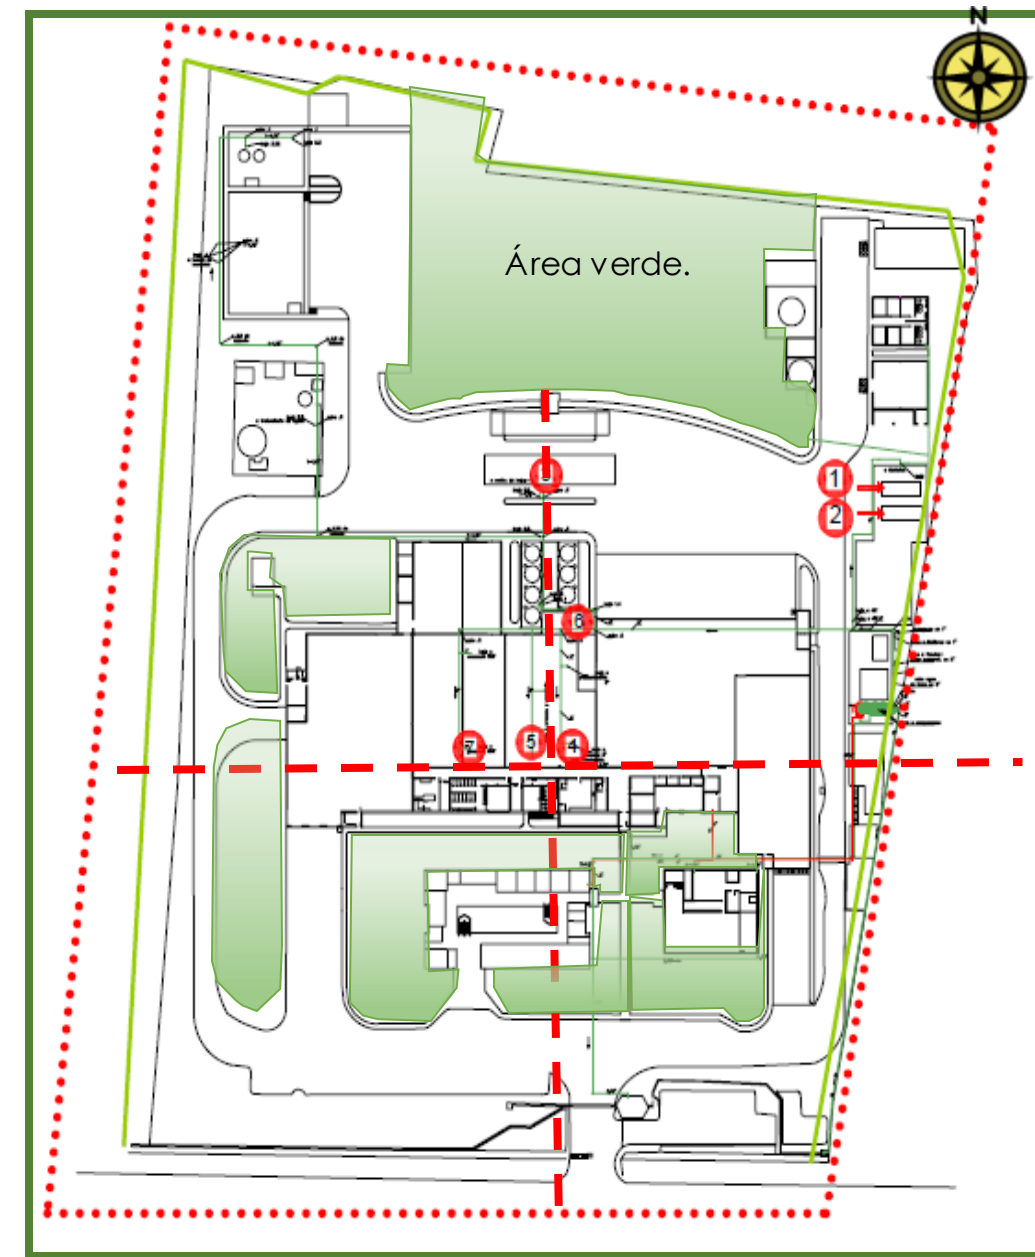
Plano Arquitectónico General de planta de procesamiento.
